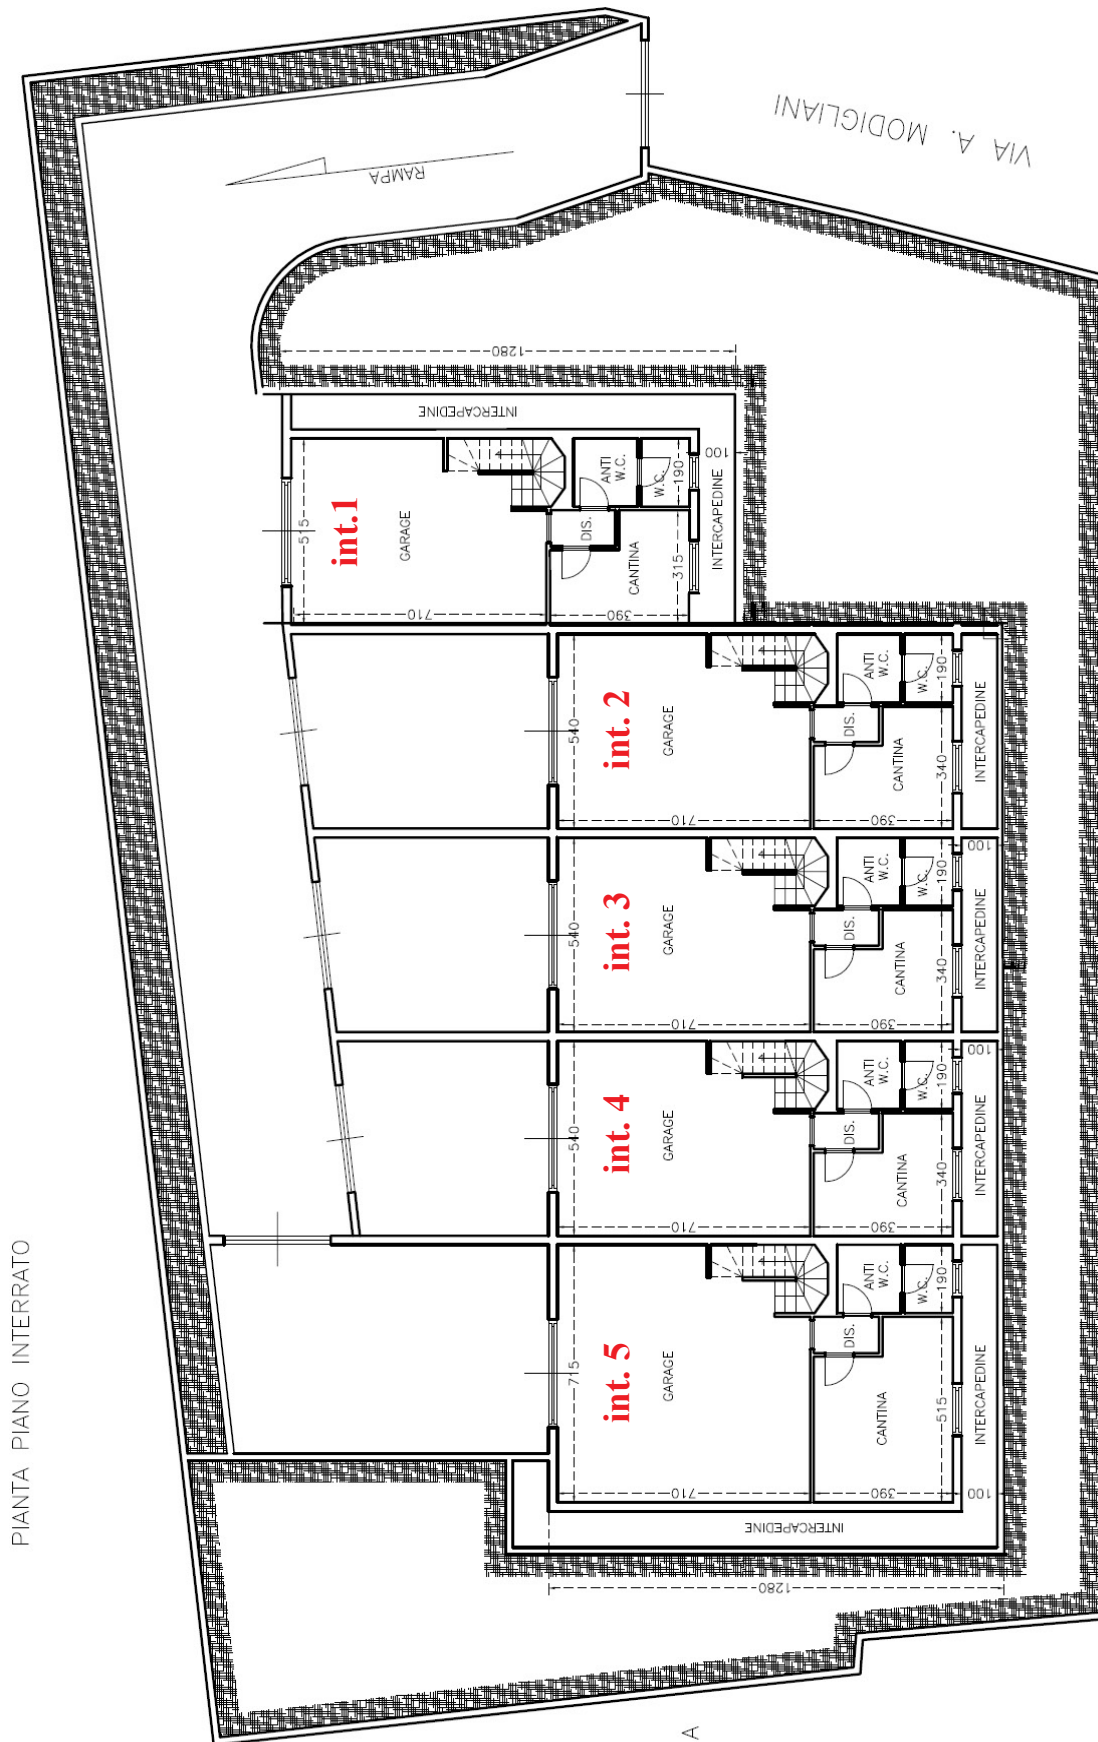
Planimetria del manufatto edilizio
